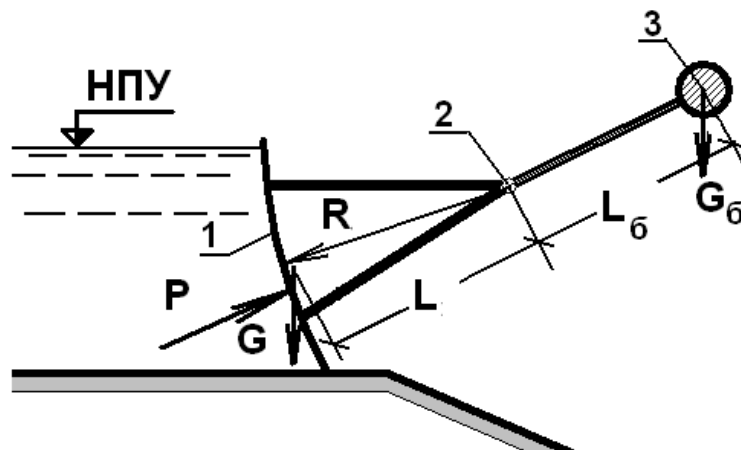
Конструкция затвора-автомата уровня верхнего бьефа с противовесом для оборудования отверстий щитовой водосбросной плотины по предлагаемому 1 – варианту реконструкции: 1 - обшивка затвора– автомата, 2 – шарнир; 3 – балансир.
